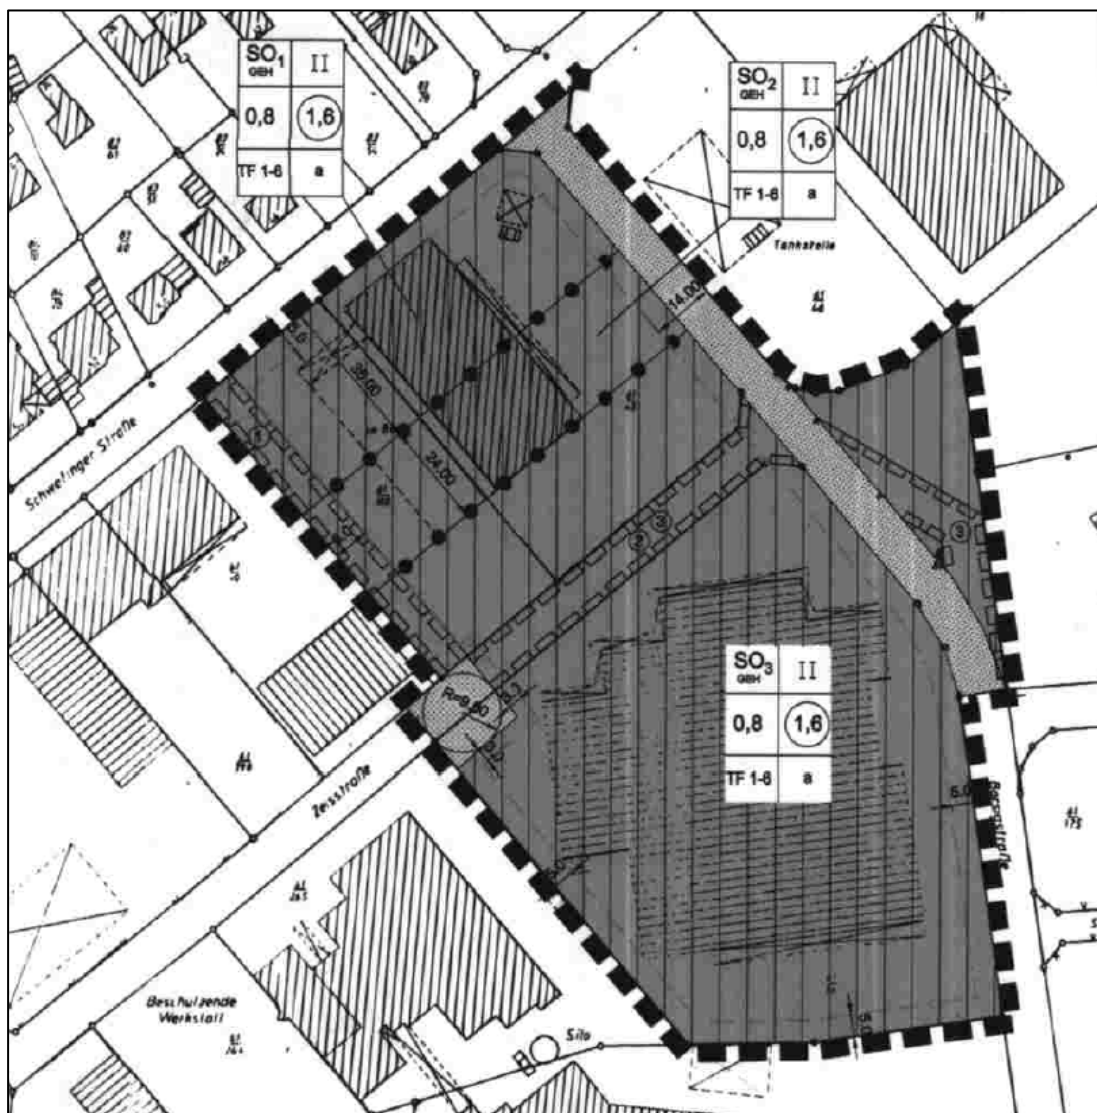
Ausschnitt aus der Planzeichnung zur 17. Änderung des B-Plan Nr. 57
